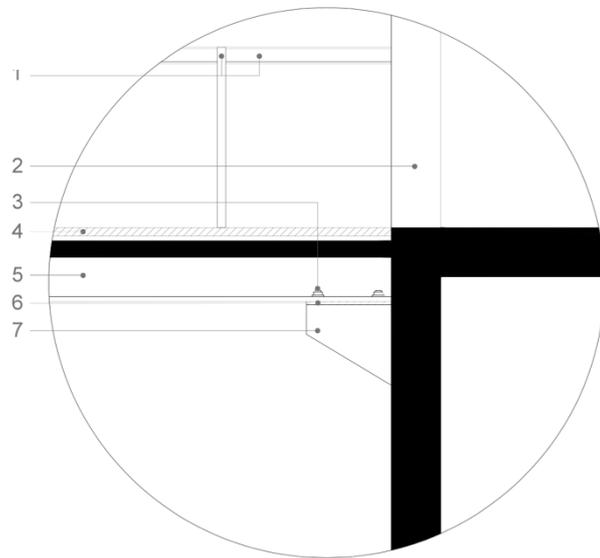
Detalle de unión puente-casa. Elaboración propia.
